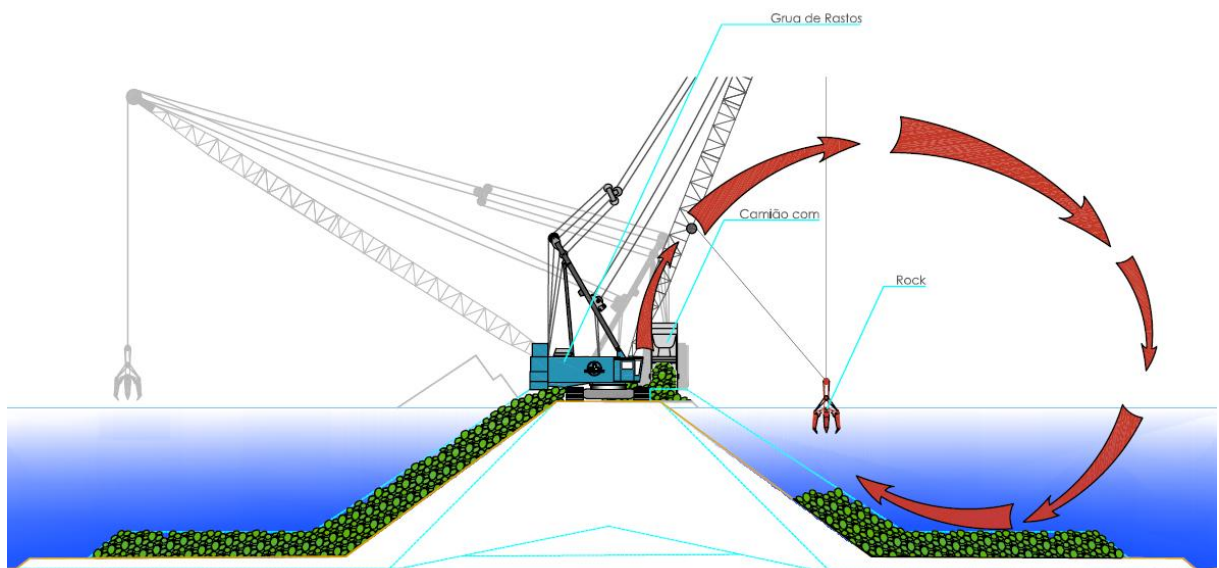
Construção da primeira subcamada, colocação enrocamento por meios terrestres, esquema em corte longitudinal 2. (ETERMAR – Engenharia e construção S.A.)
